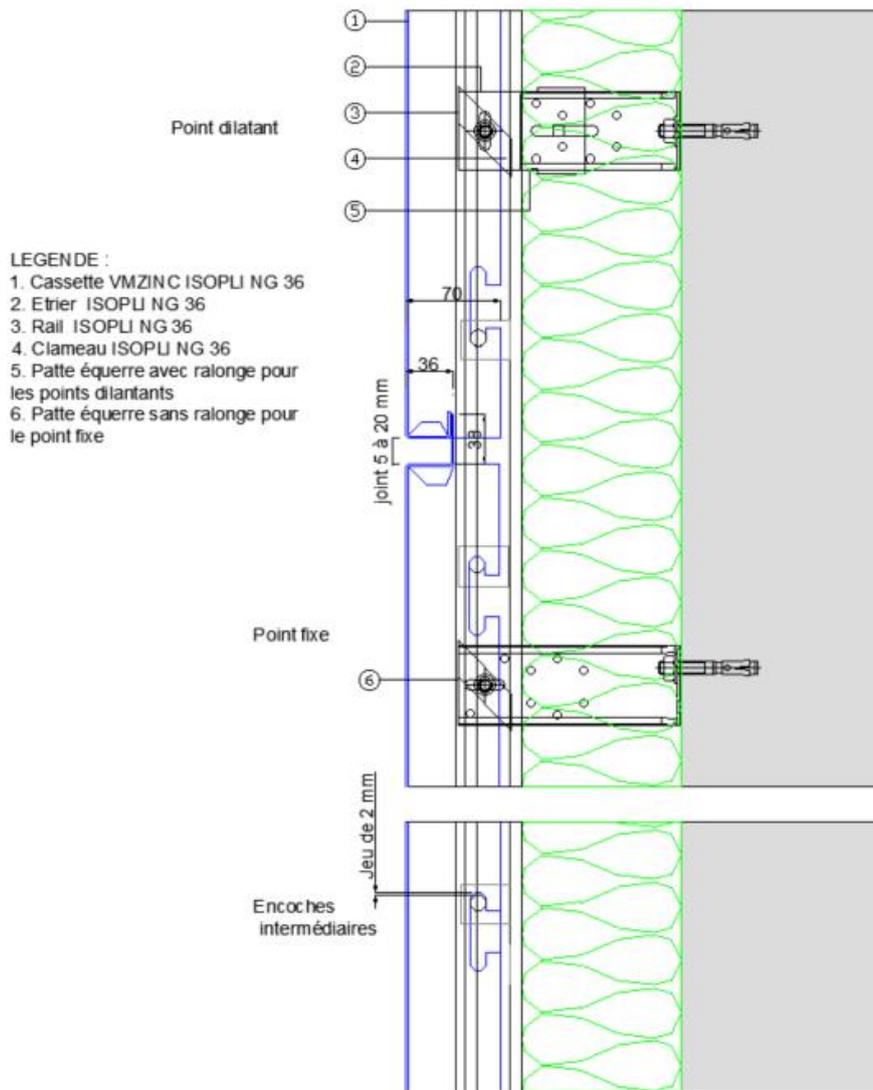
Joint horizontal (coupe verticale) avec rails ISOPLI NG dilatants de 3 à 6 m
